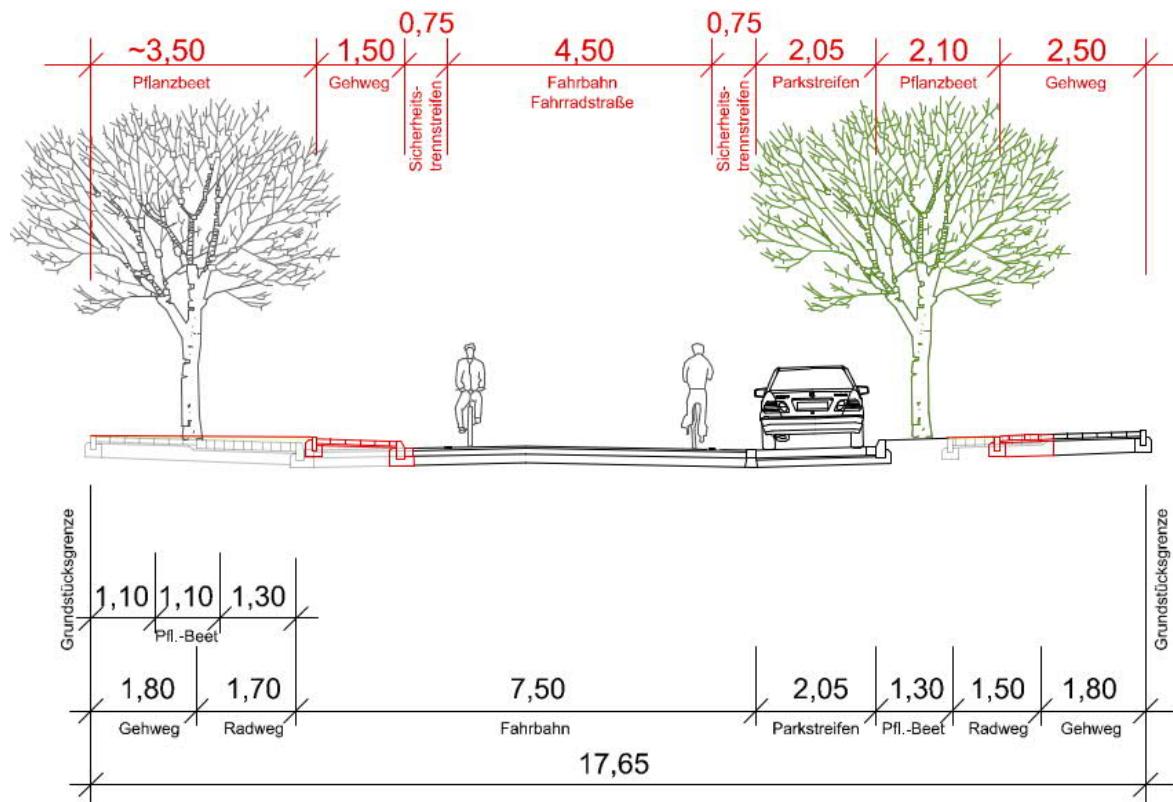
Möglicher Querschnitt Kardinal-von-Galen-Str. als Fahrradstraße (Rtg. Osten) (Maße oben Planung, unten Bestand)
